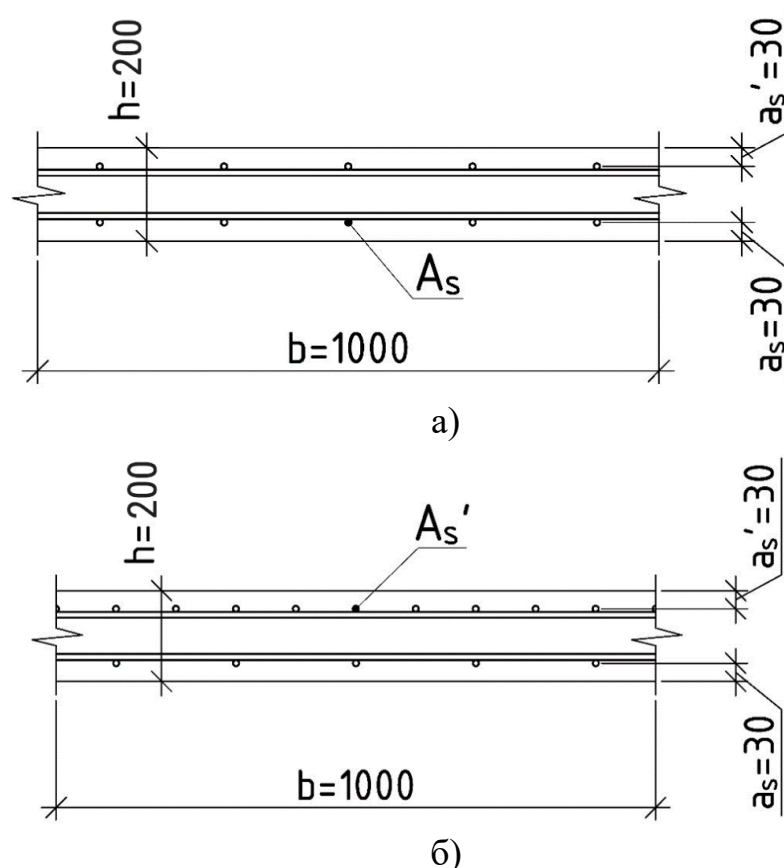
Розрахункові перерізи плити перекриття: а – пролітний, б – опорний
